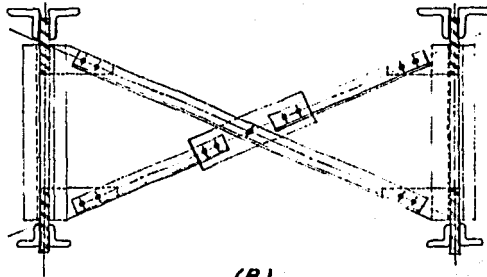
Arreglo en planta en tres planos longitudinales verticales de contraenteco entre armaduras para impartir estabilidad adicional (Ver corte C-C).
